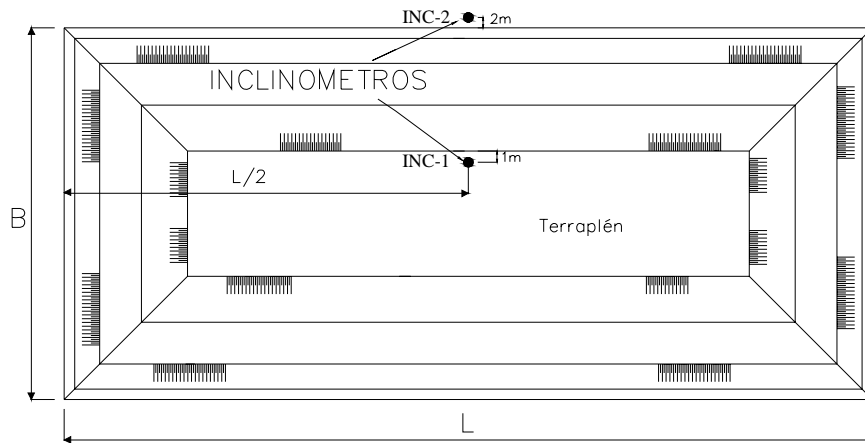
Propuesta de ubicación en planta de los inclinómetros para los terraplenes de prueba TR-3, TR-4 y TR-5
